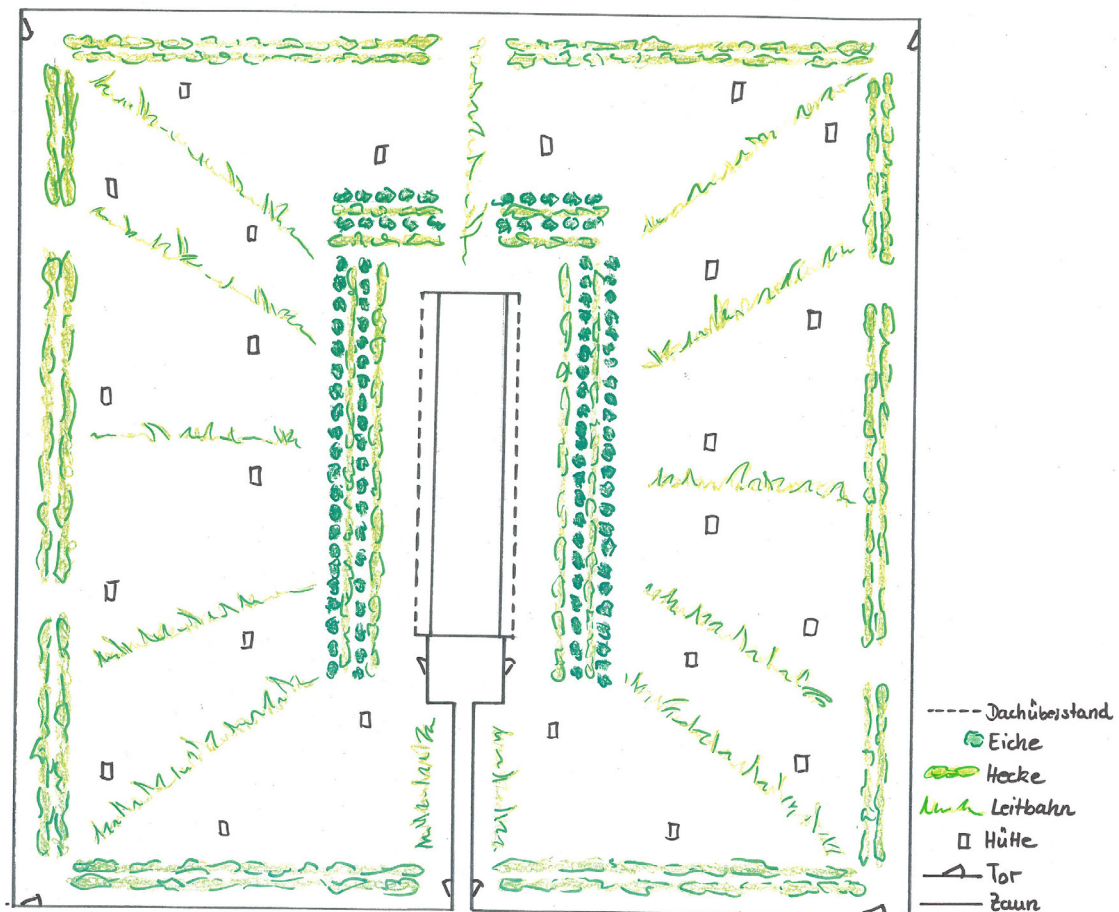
Skizze: Grundriss – Planungsbeispiel 1
